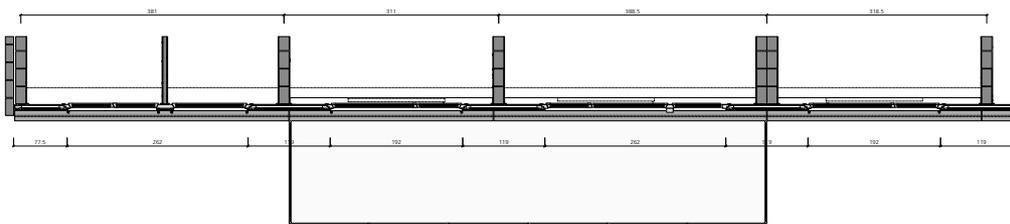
Bestehender Grundrissausschnitt
